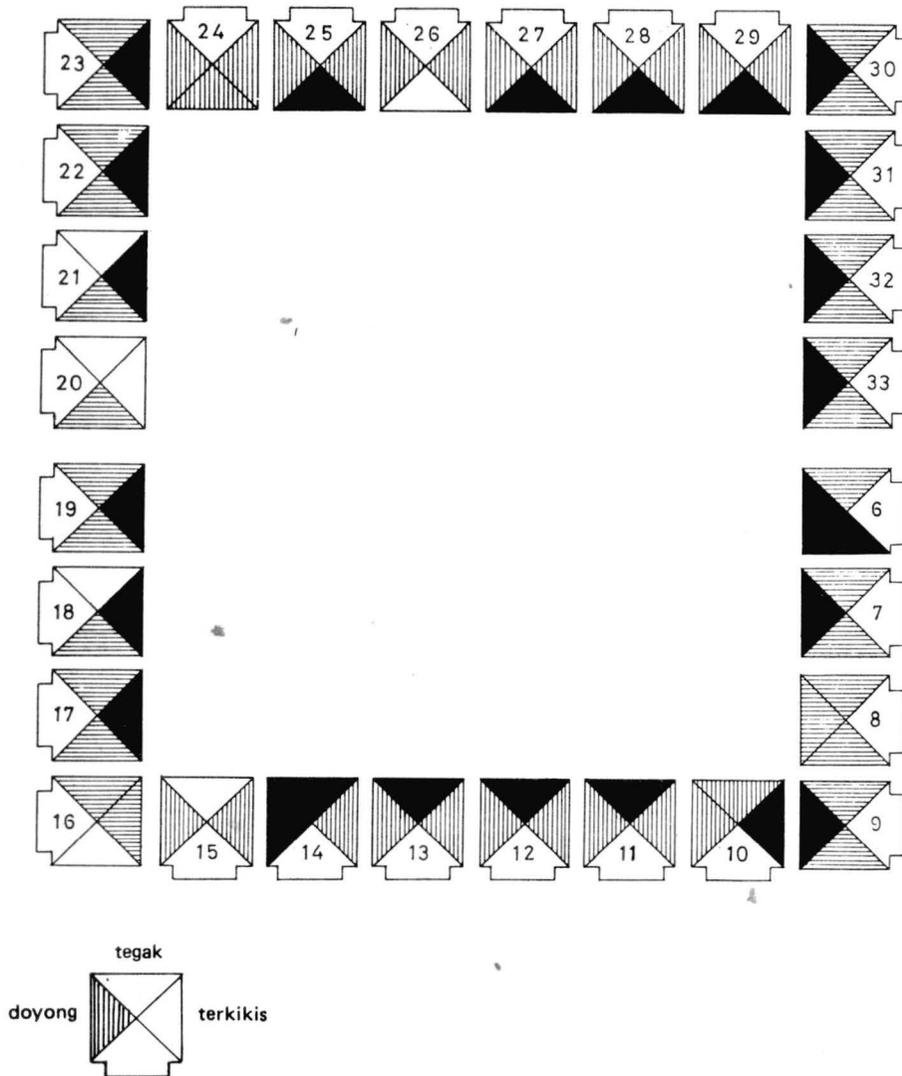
Candi Plaosan Lor. Lantai Bangunan C.
